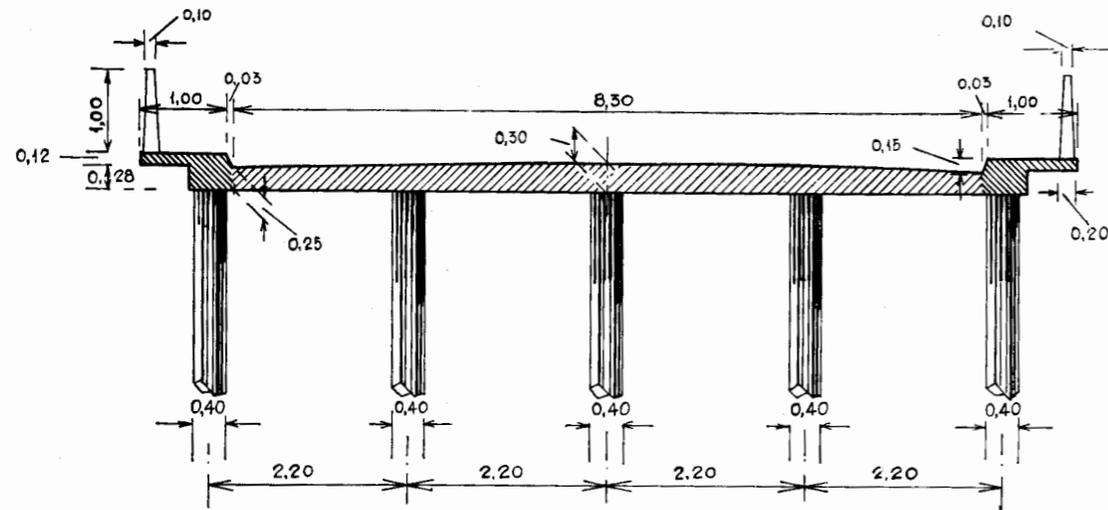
Puentes sobre los ríos Samborombón y Salado. - Se aprecia en la sección del puente que, en unidad, es una losa sin vigas y en carácter particular, la zona sombreada de vereda y espesor de losa trabaja como viga de apoyo de la losa cruzada en el sentido transversal de la vía, en tanto el apoyo en el sentido longitudinal del puente son los refuerzos que se han realizado sobre la cabeza de los pilotes.
